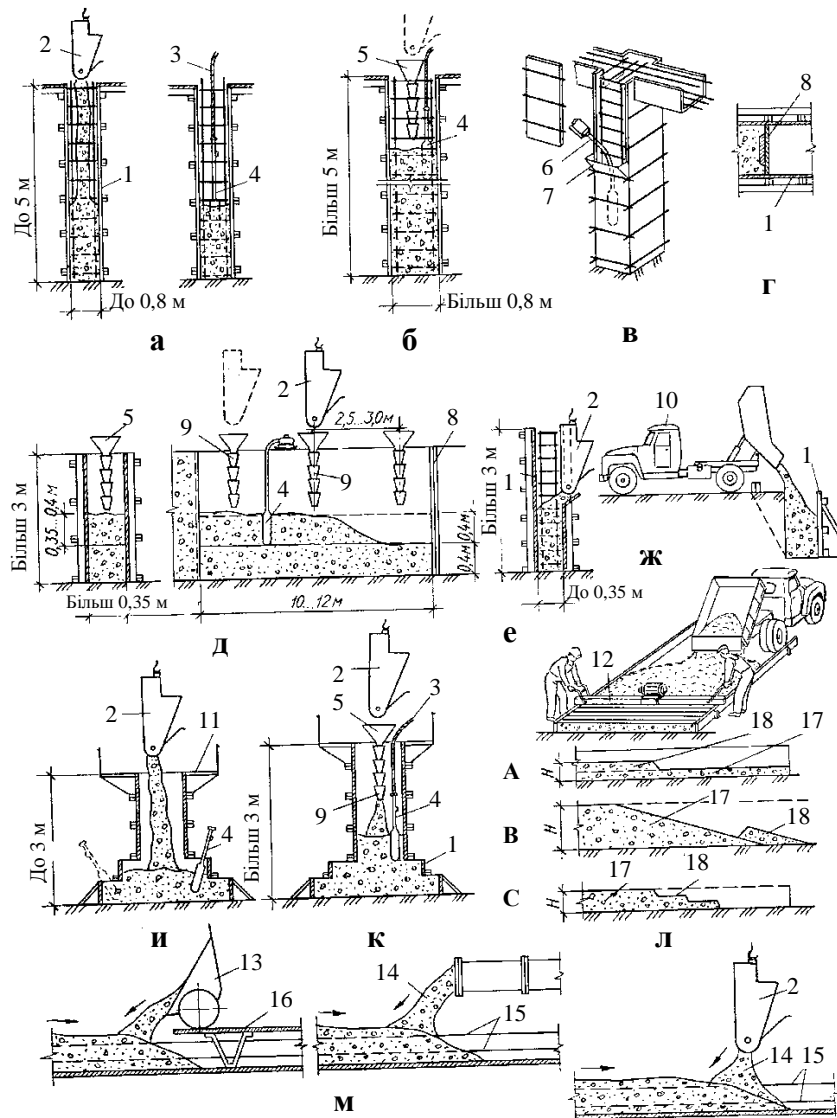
Схеми бетонування: а – колони до 5 м заввишки; б – колони більше 5 м заввишки; в – колони в разі густої арматури балок; г – установлення щита розподільної опалубки; д – товстої стіни; е – густоармованої тонкої стіни; ж – підпірної стіни; и – східчастого фундаменту до 3 м заввишки; к – те саме, більше 3 м заввишки; л – плити по ґрунту (А – горизонтальними шарами; В – похилими шарами; С – ступенями); м – плити для підготовки; 1 – опалубка; 2 – цебер; 3 – мотузка; 4 – глибинний вібратор; 5 – лійка хобота; 6 – вібратор з гнучким валом; 7 – кишеня; 8 – розподільний щит; 9 – хобот; 10 – автобетоновоз; 11 – підмостки; 12 – вібробрус; 13 – тачка; 14 – бетонна суміш; 15 – арматура; 16 – качальний хід; 17 – покладений шар бетону; 18 – укладення шару бетонної суміші
